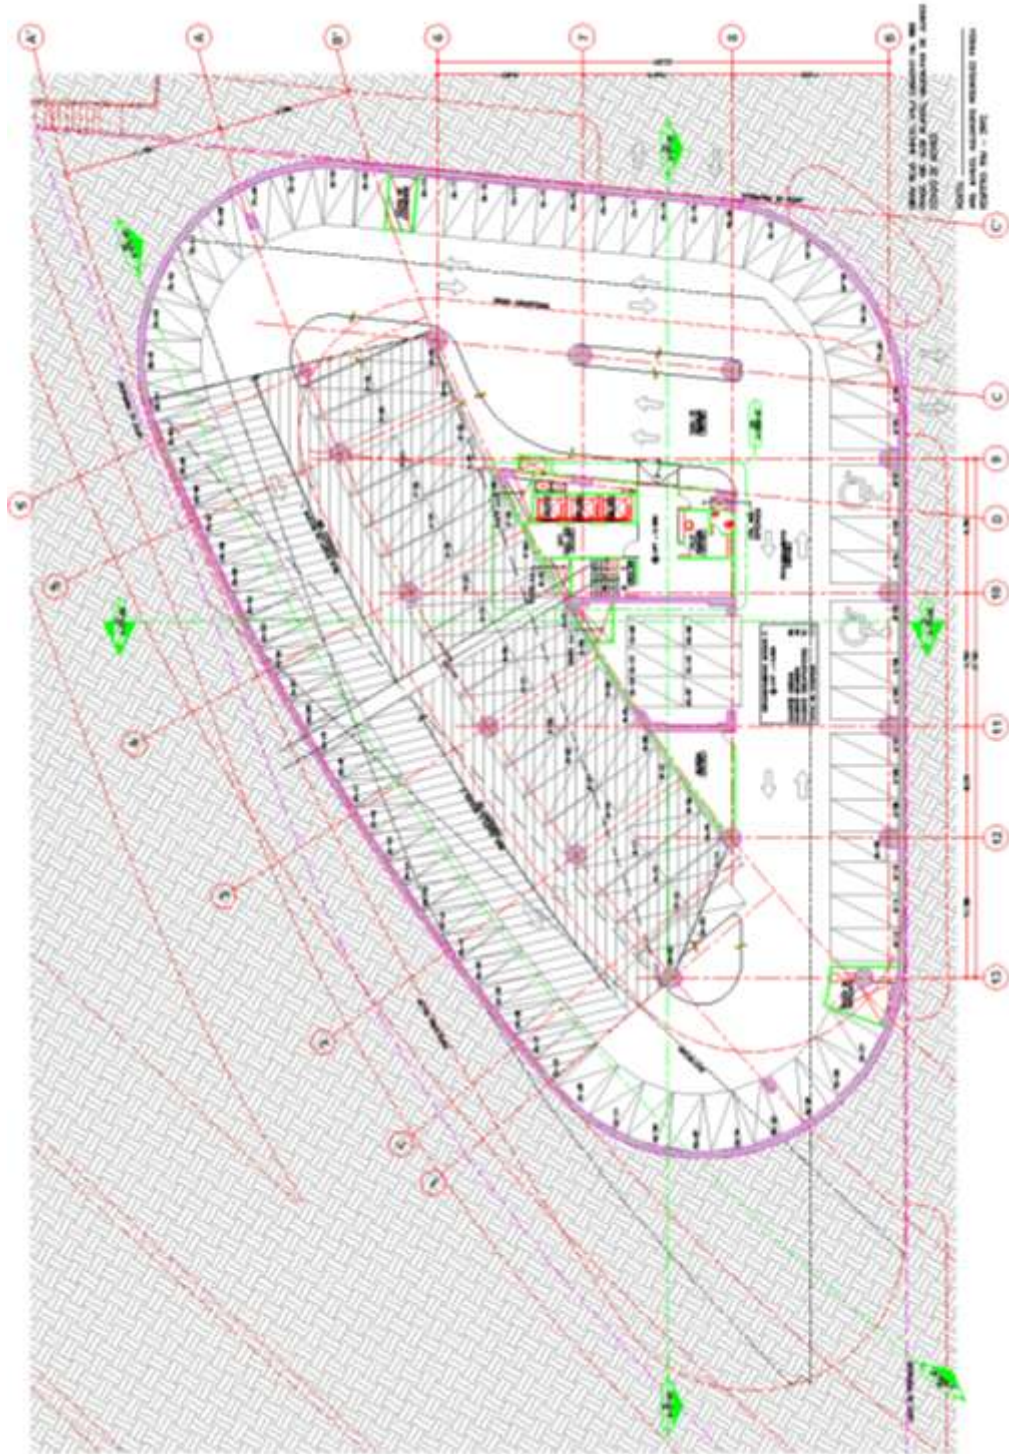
ANTEPROYECTO PLANTA ARQUITECTONICA SOTANO 2
